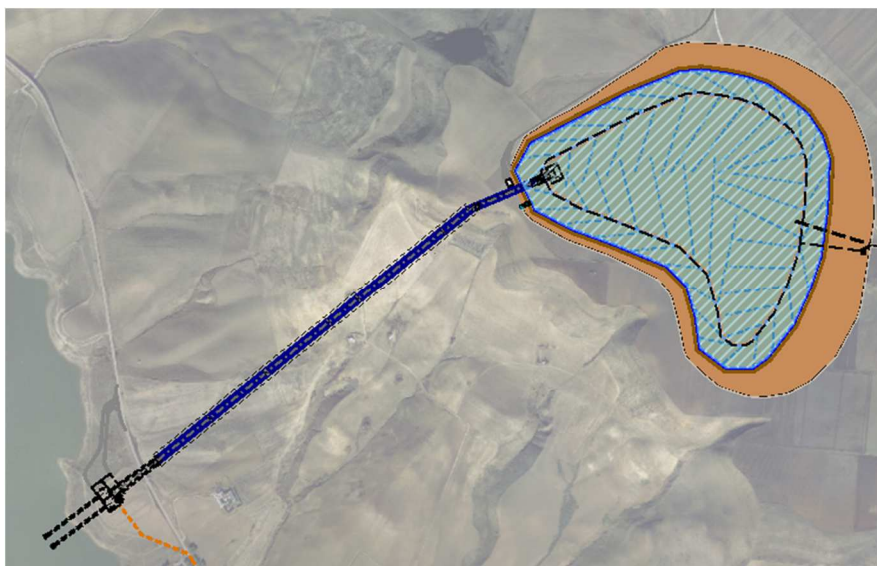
Estratto della planimetria di progetto delle opere di impianto.
